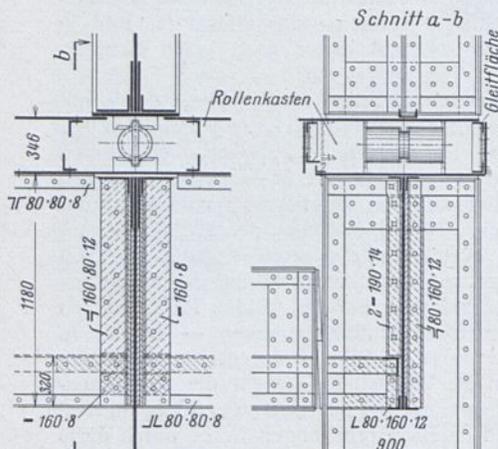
Rollenlager, Rollenkasten und Lagerung der Seitenhallenbinder.
